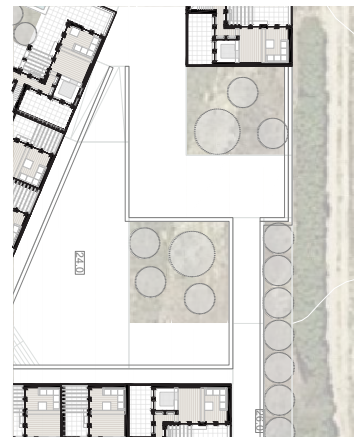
Planta pátio do quarteirão aberto maior 1:1000
